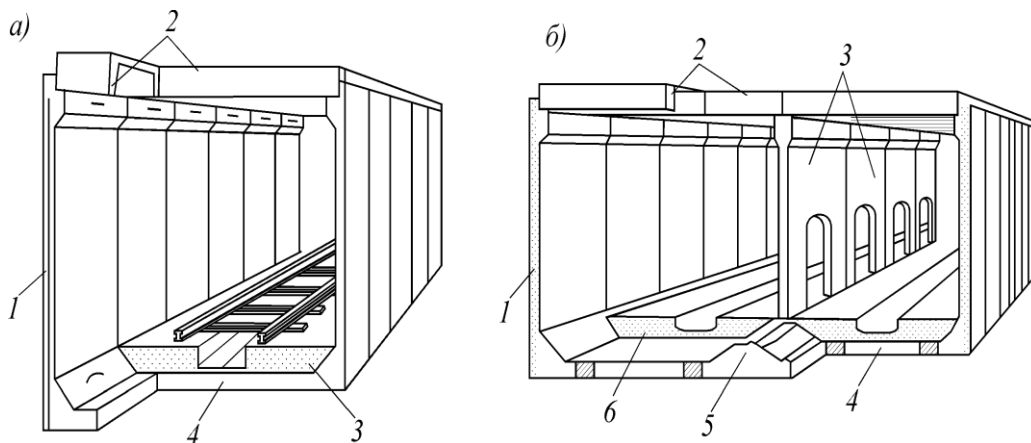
Обробка перегінних тунелів відкритого способу робіт із збірного залізобетону: *a* – для одноколісного тунелю: 1 – стіновий блок; 2 – блок перекриття; 3 – бетонна основа під шлях; 4 – лотковий блок; *б* – для двоколісного тунелю: 1 – стіновий блок; 2 – блок перекриття; 3 – розділові блоки між тунелями; 4 – лотковий блок; 5 – лотковий блок для розділової стіни; 6 – бетонна основа під шлях
